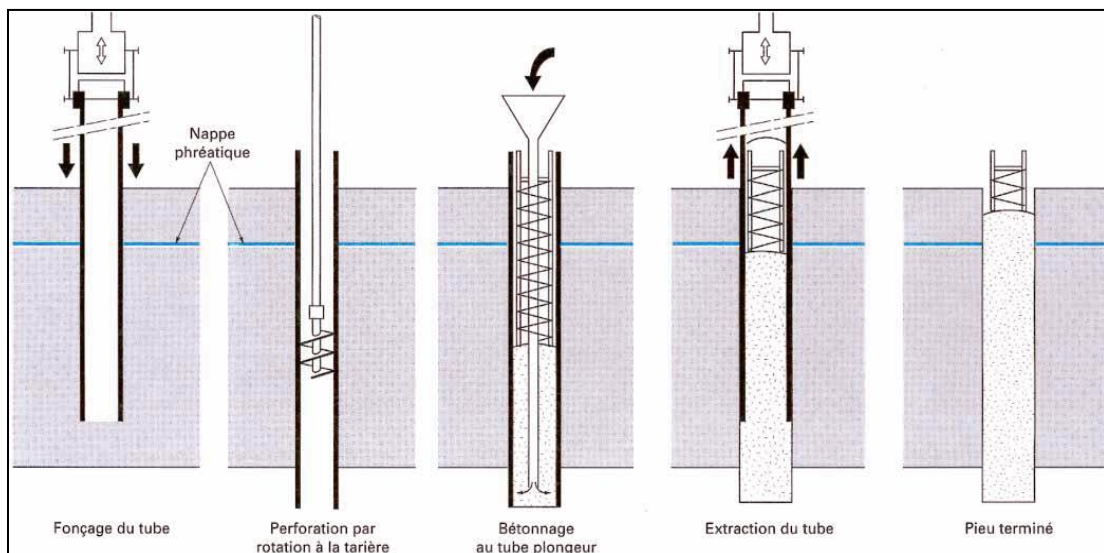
Pieu foré tubé (d'après doc. Études et travaux de fondation).
